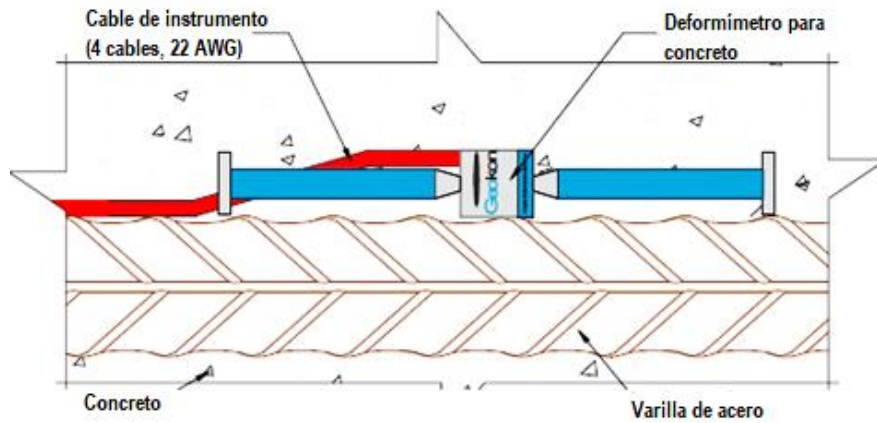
Deformímetro para concreto (GEOKON, 2018)
